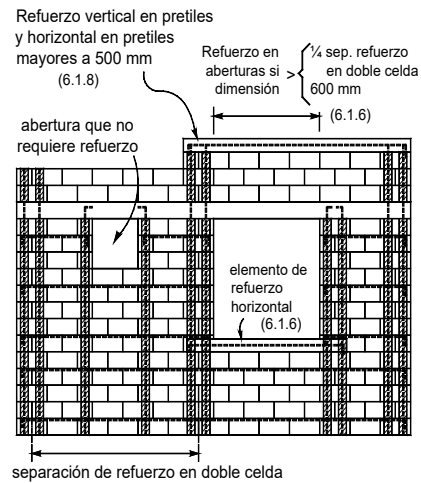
REFUERZO EN ABERTURAS Y PRETILES
